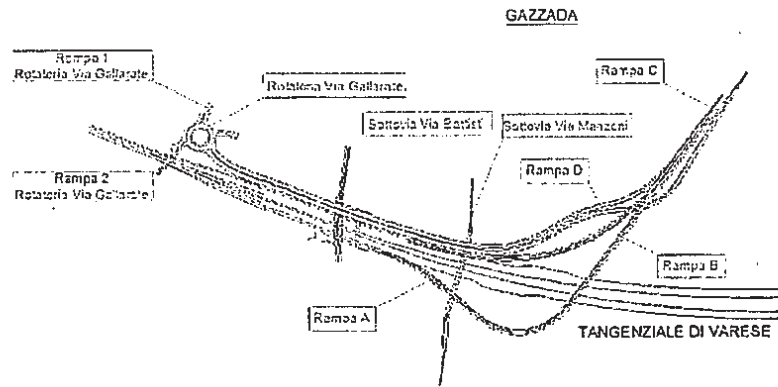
Schema planimetrico - svincolo Gazzada-Morazzone
